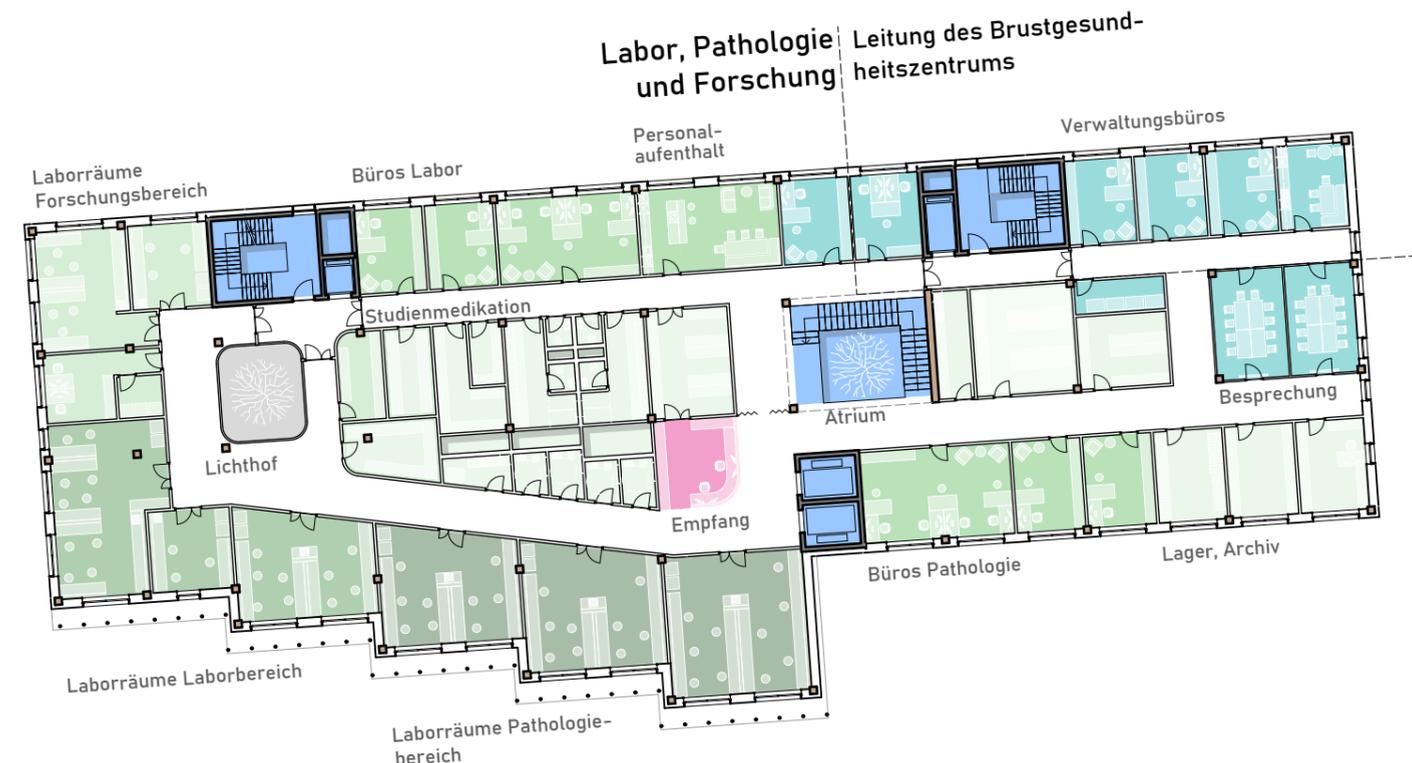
Grundriss 3.OG Raumorganisation M1:400
